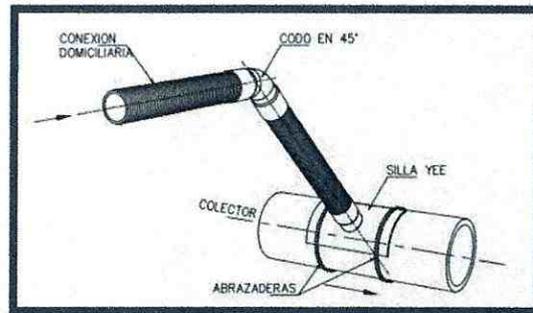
Detalle isométrico de acometidas en pavimento rígido
